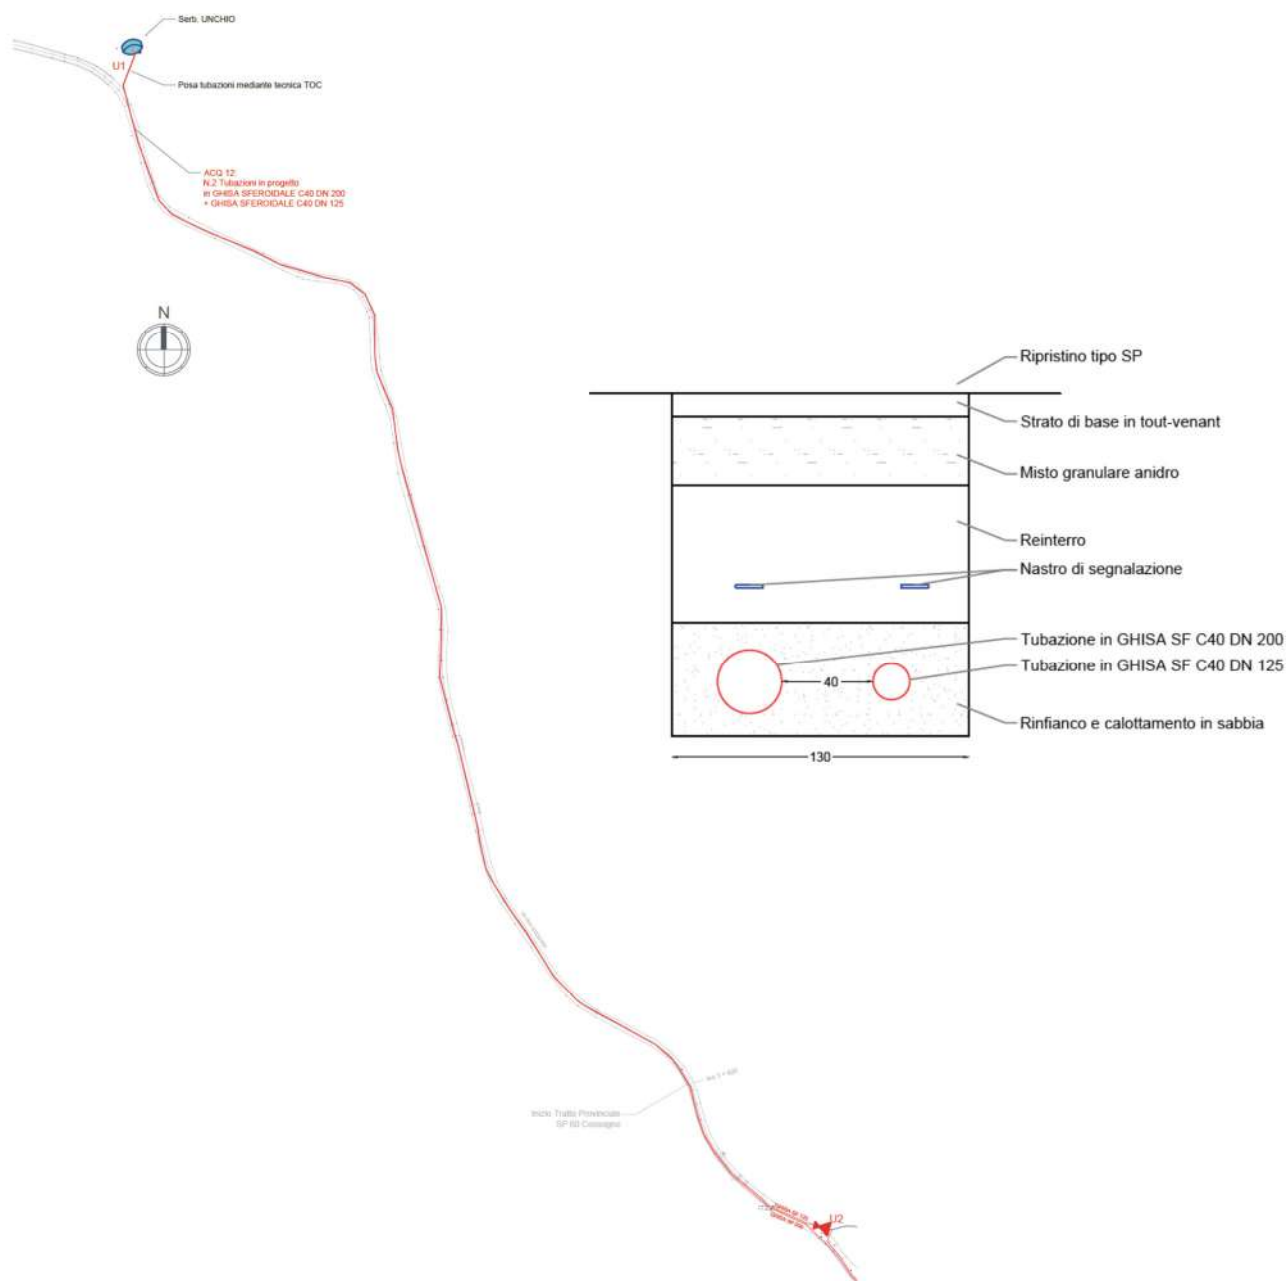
Planimetria dell'intervento in previsione e sezione tipo di progetto
